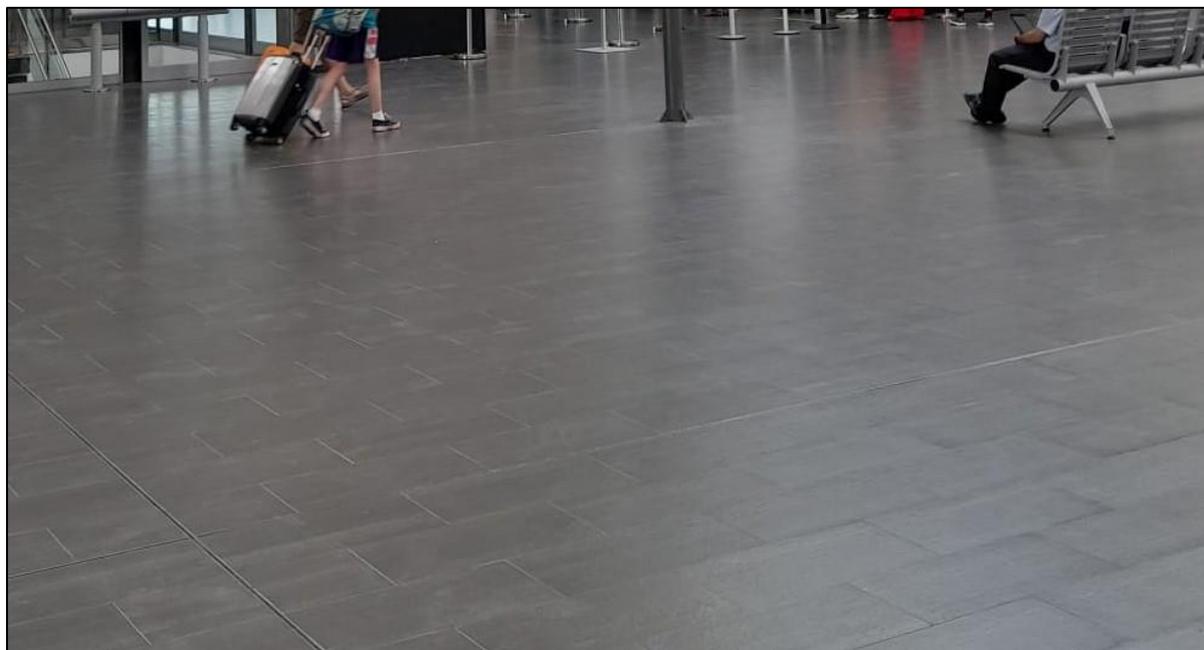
Pavimento antideslizante en la estación Segovia Guiomar
